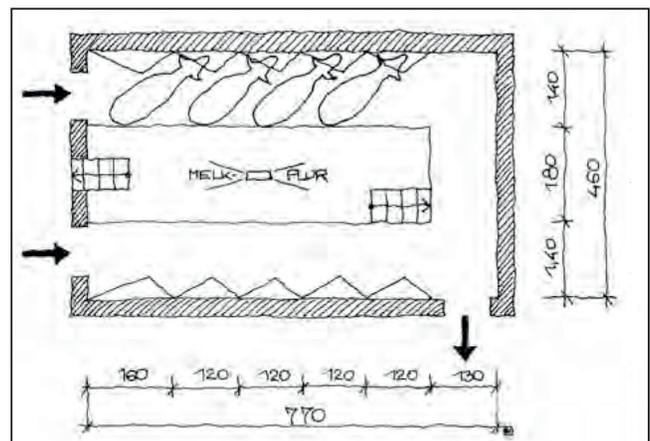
Grundriss Fischgrätenmelkstand.
